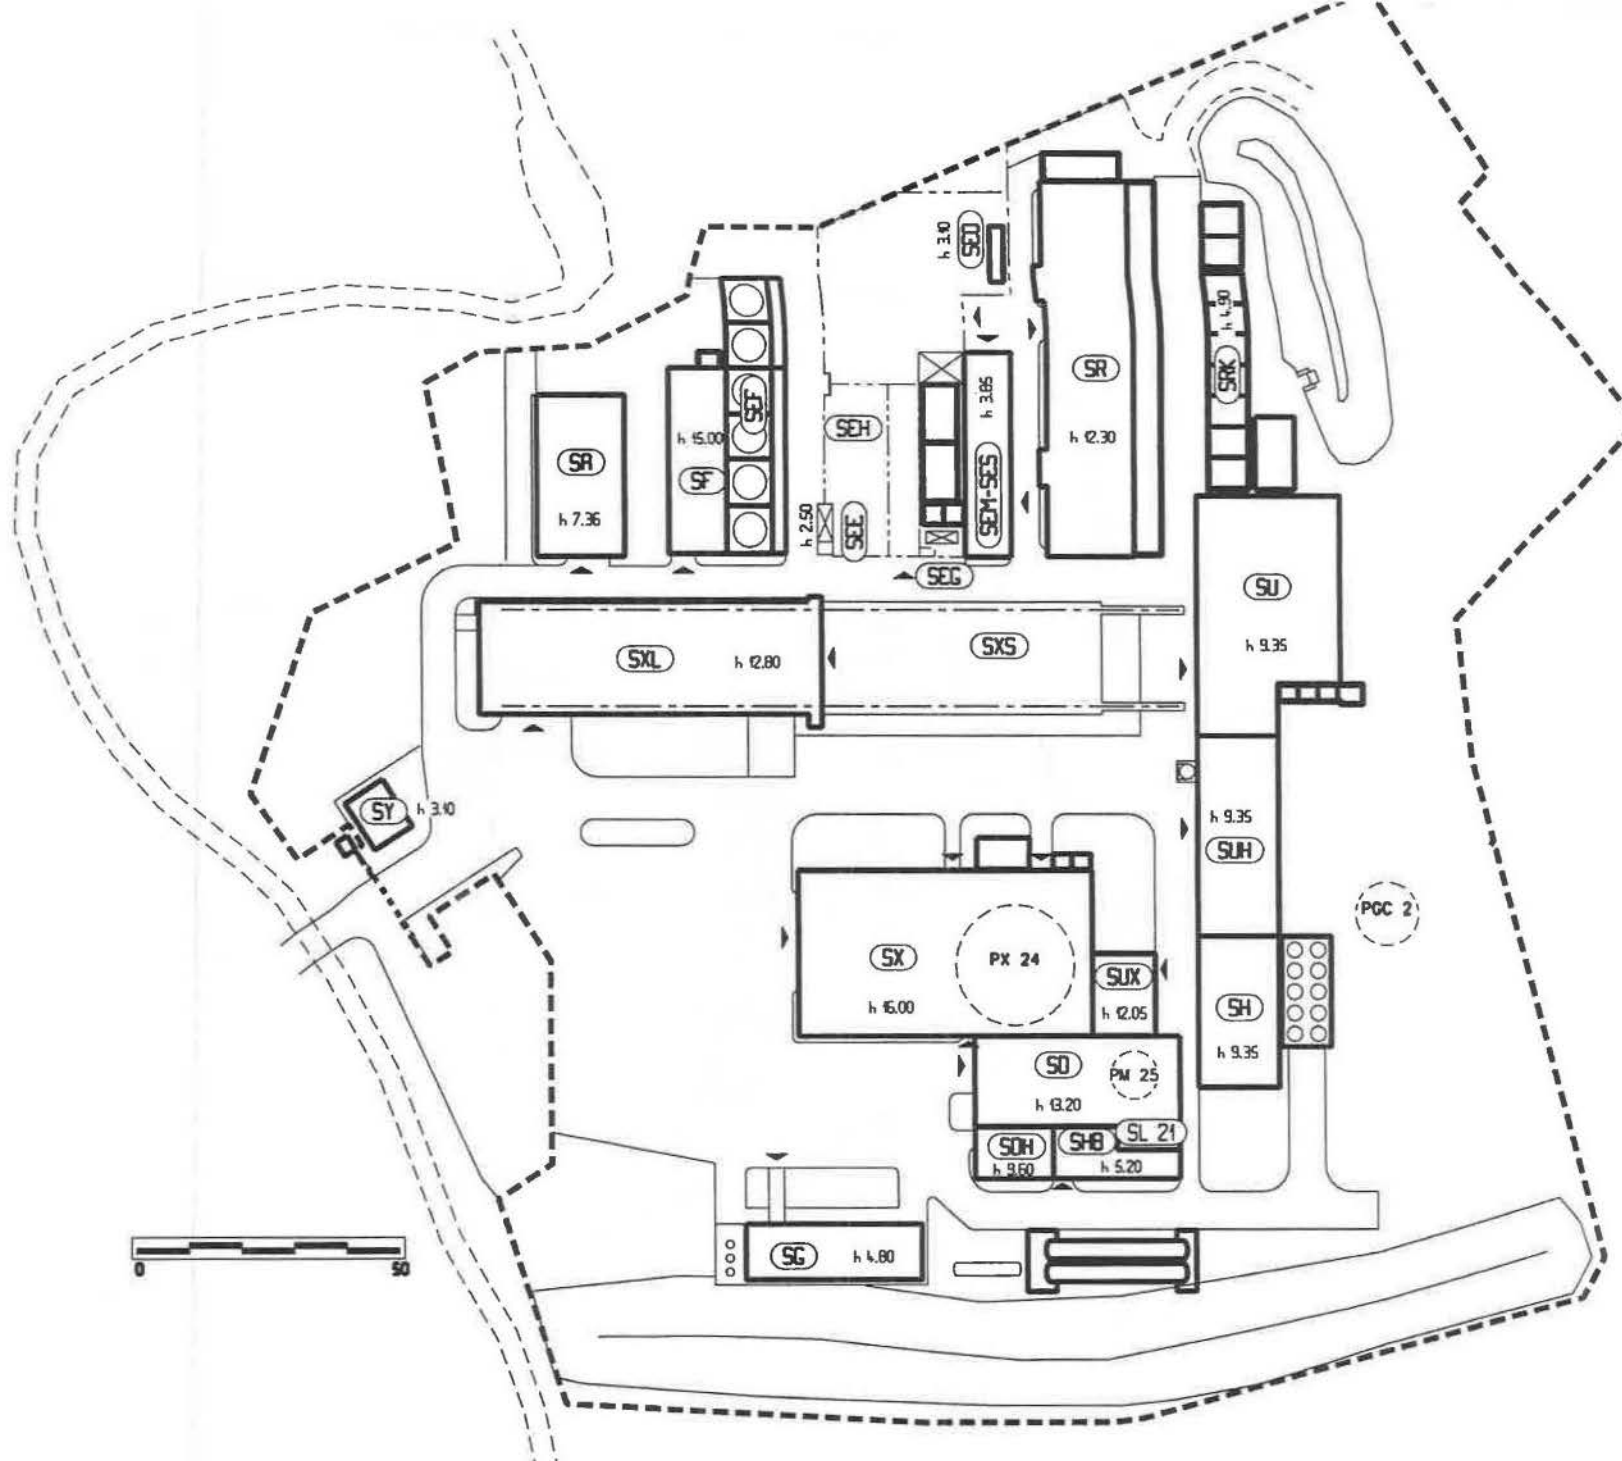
Point 2 : Plan de masse des bâtiments en surface du LHC
